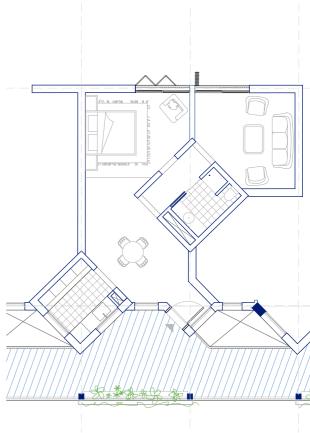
Plano de planta del modelo de vivienda 3H. Elaboración propia
